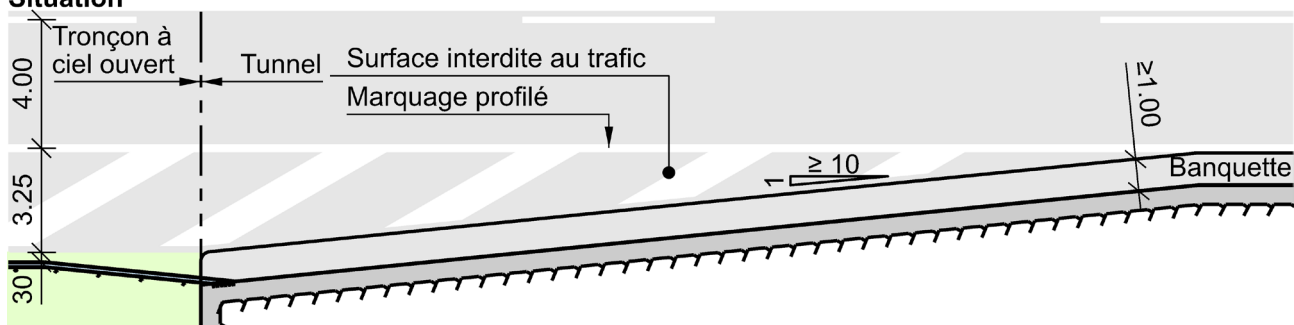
Variante 5 – Élargissement du profil du tunnel dans la zone du portail
